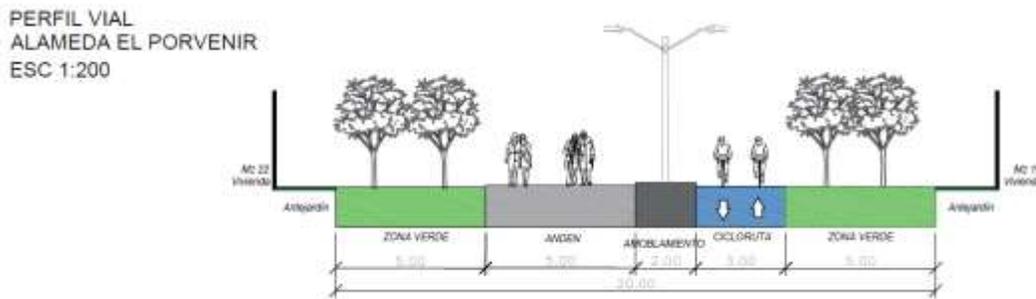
Detalle de la continuidad de la Alameda El Porvenir en Plan Parcial
